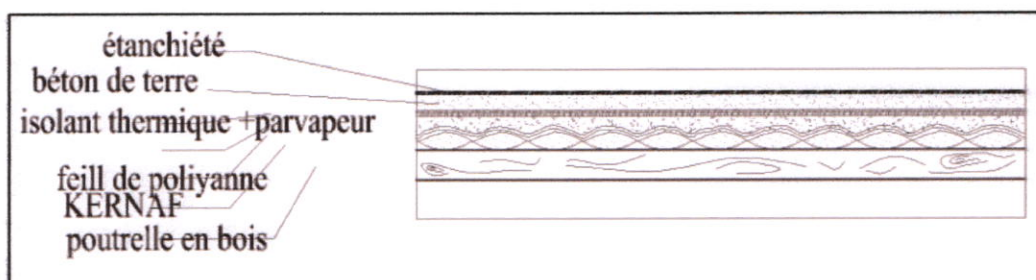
Détail de plancher à Kernaf (Source : auteur)
